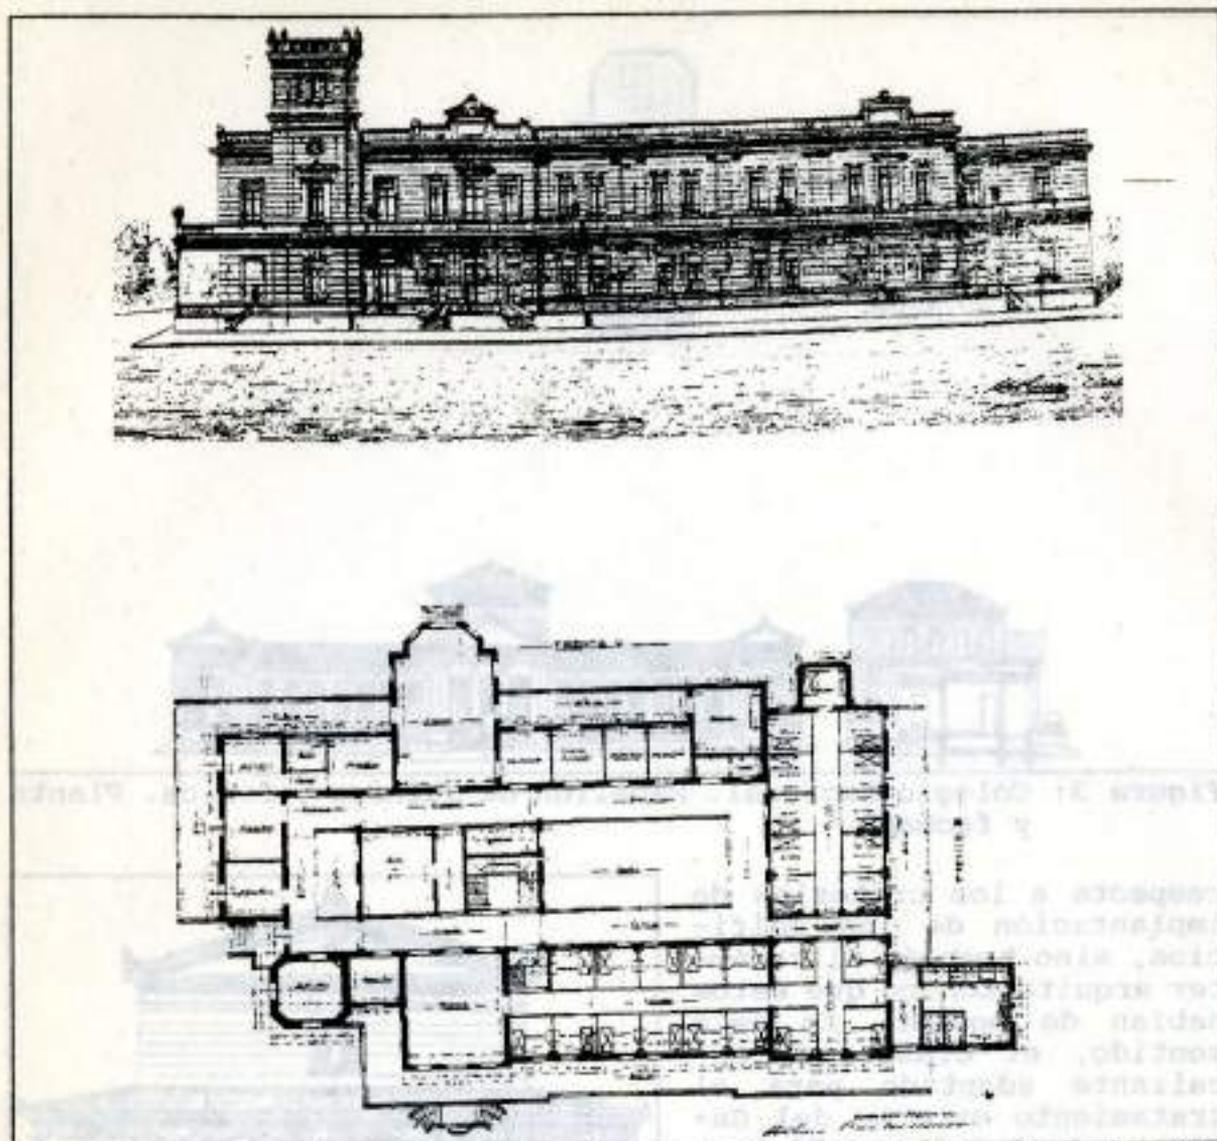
Colegio Nacional. Internado N°1. Fachada sobre Avenida 1 y planta baja.
